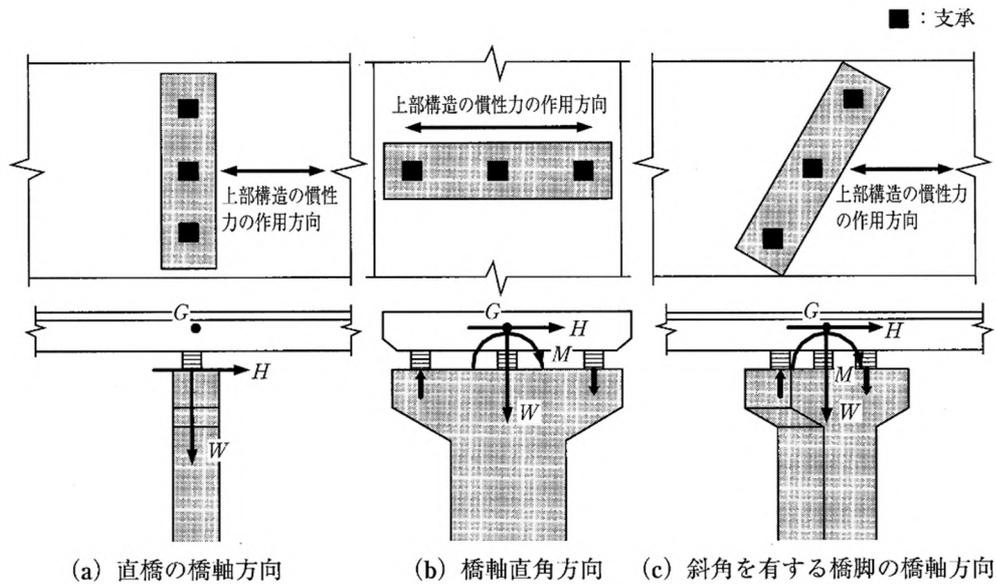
下部構造の耐震設計における上部構造慣性力作用位置と下部構造頂部に作用する荷重
